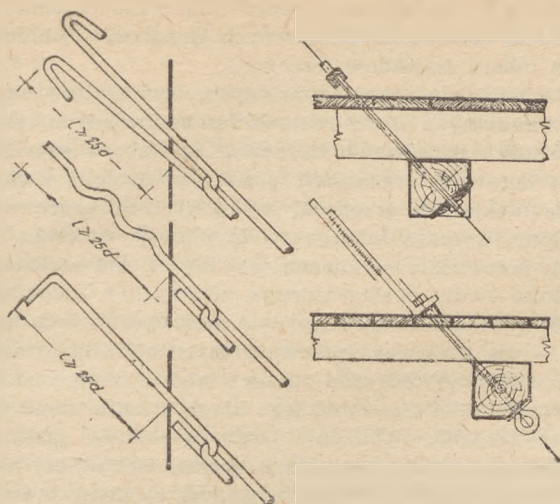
Zabezpieczenie ścian przeciw parciu betonu.
